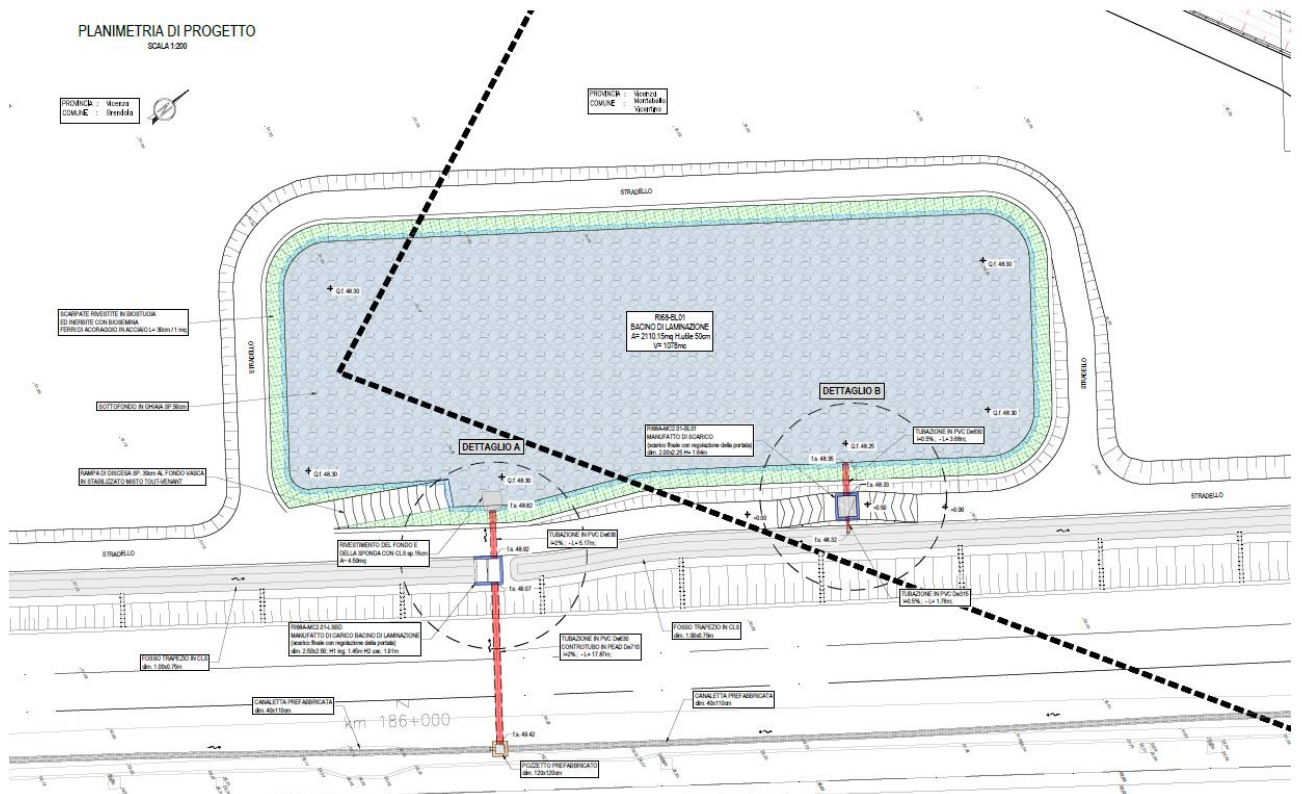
Planimetria di progetto del bacino di laminazione RI68A-BL01
